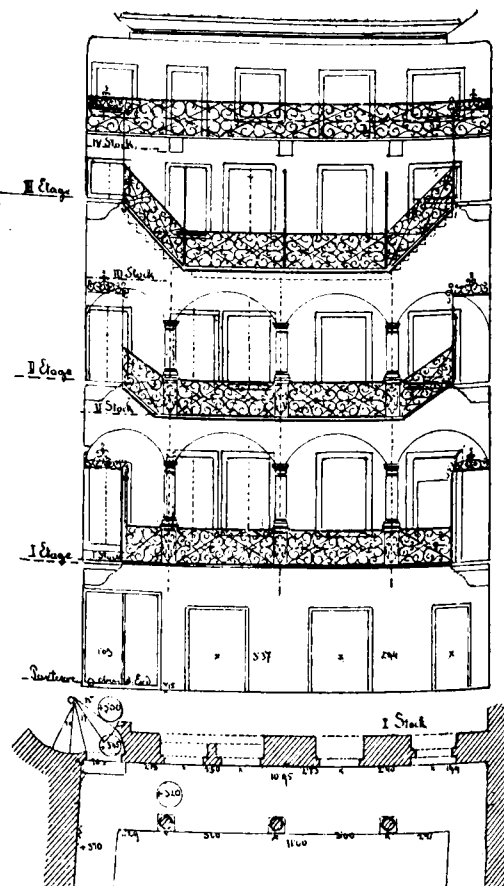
Grundriss und Aufriss der Galerie.
